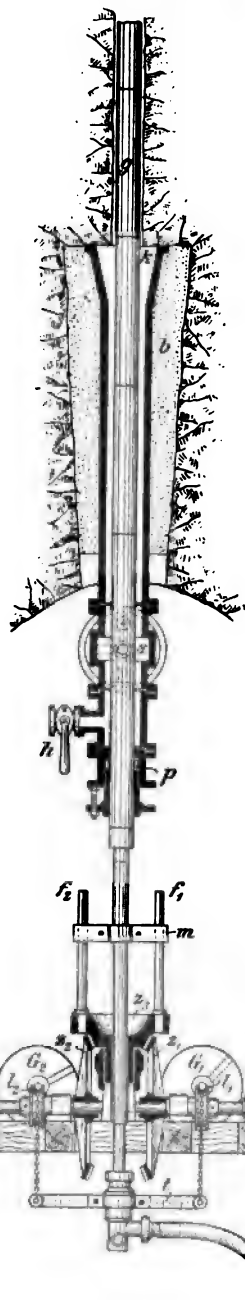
Einrichtung zum Anbohren ersoffener Baue.
